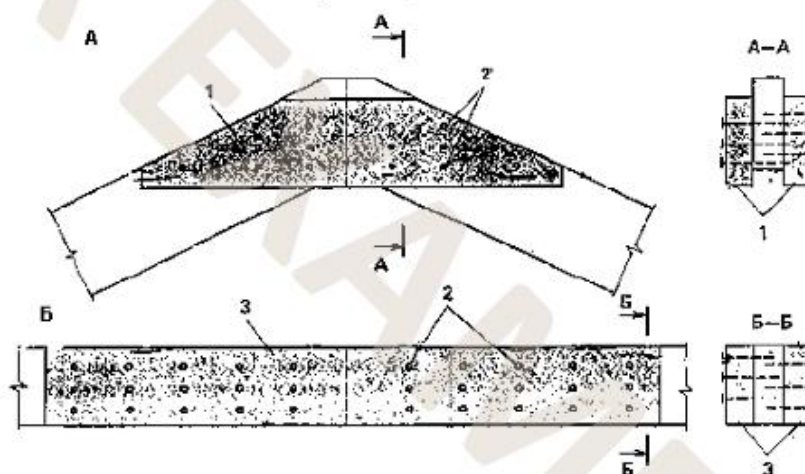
Узлы дощатых ферм А - верхняя накладка; Б - нижняя накладка; 1 - фигурная накладка; 2 - гвозди; 3 - прямоугольная накладка
